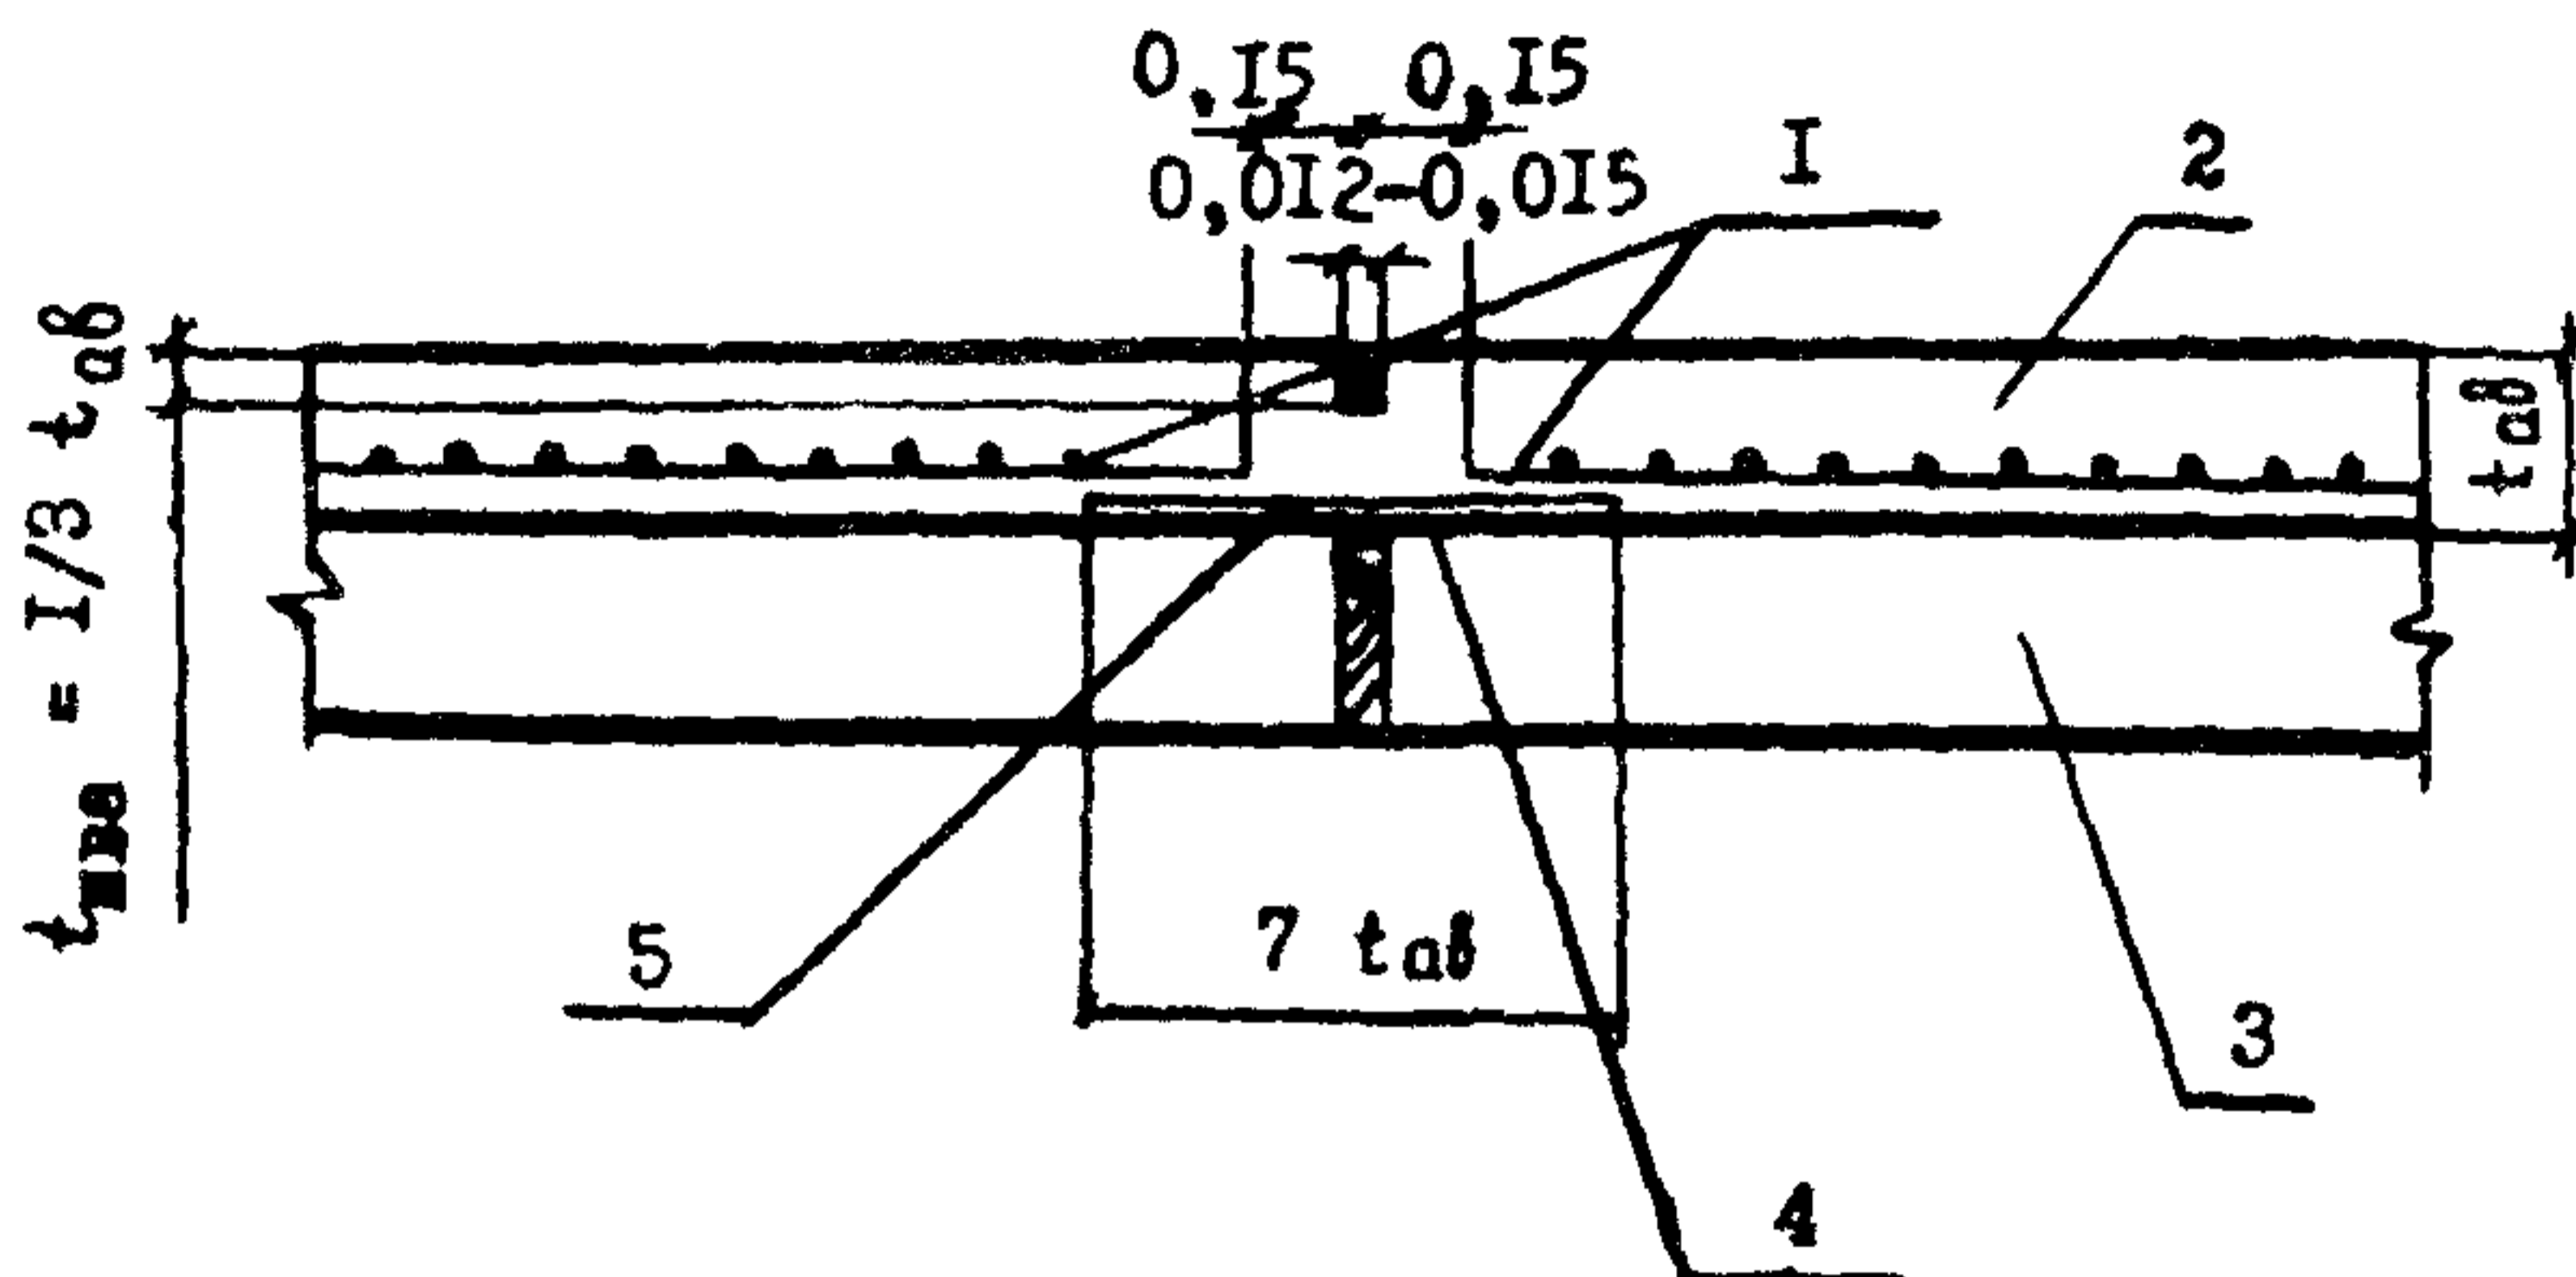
Однослойное асфальтобетонное покрытие: I – стеклопластиковые сетки; 2 – слой усиления из асфальтобетона; 3 – существующее жесткое покрытие; 4 – побелка известковым молоком; 5 – пергамин
